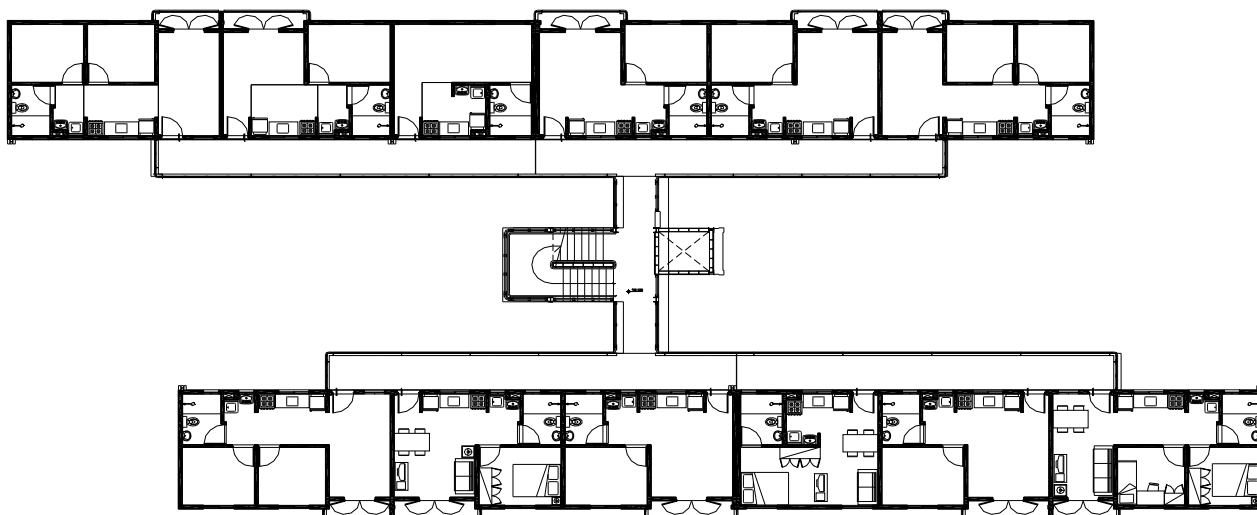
Planta Pavimento Tipo – C. H. Parque do Gato
